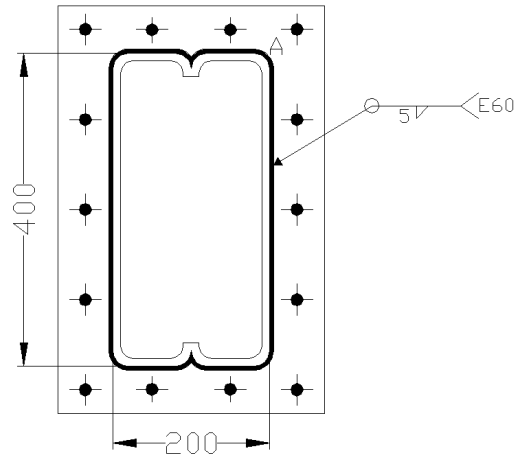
Detalhe da solda entre o perfil e a chapa de ligação
